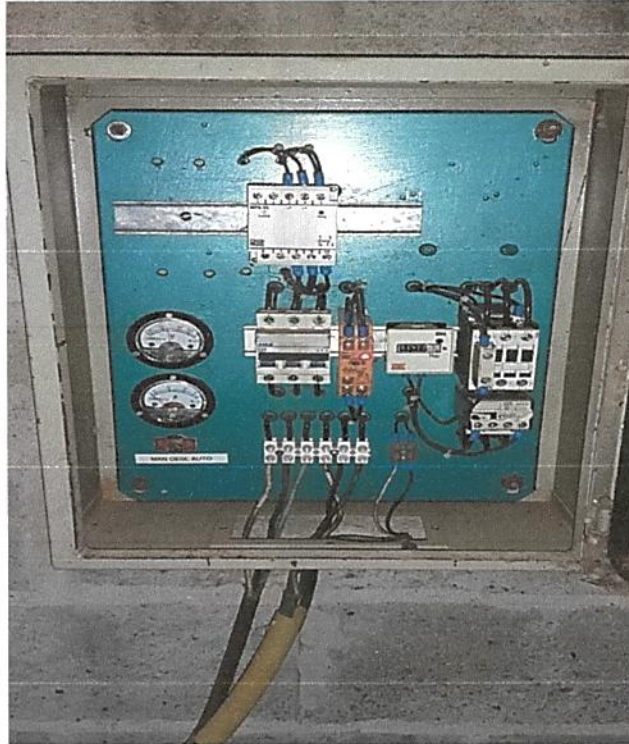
Central de controle da bomba e Horímetro do poço tubular.
